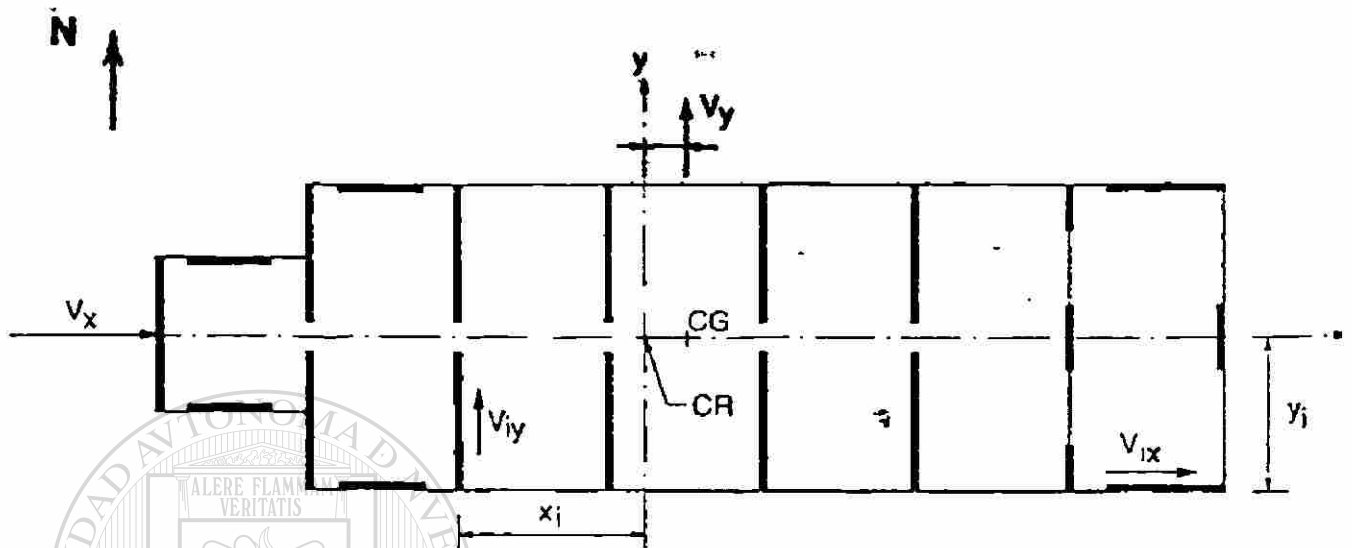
Planta tipo de muros de cortante de mampostería en un edificio de varios niveles.
